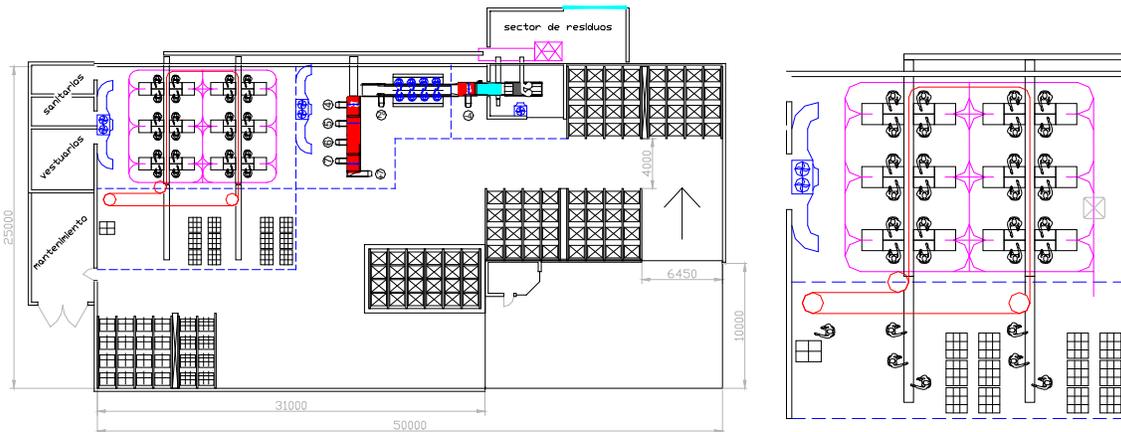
Vista en planta de un galpón de empaque de ajo con sistemas de eliminación de polvos e inertes
